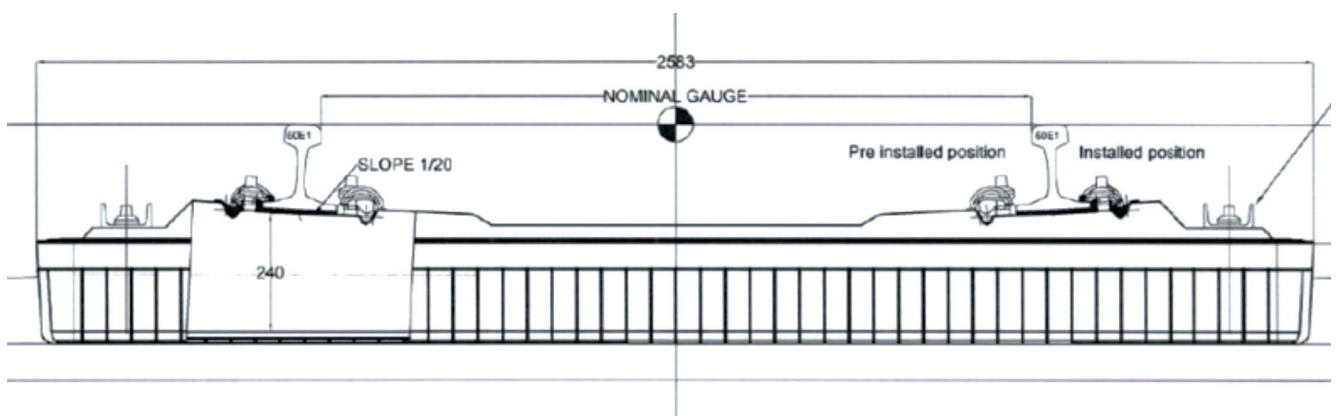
Exemple traverse HAS avec chausson (équipée d'attaches prémontées et de rail UIC60)
